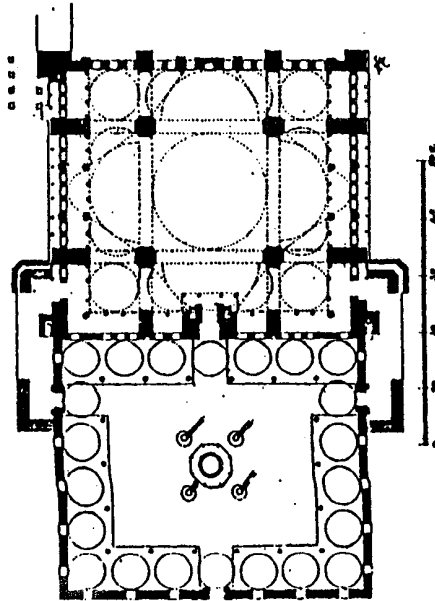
مسقط أفقي لجامع شاهزاده باستانیول (عن : Goodwin)
